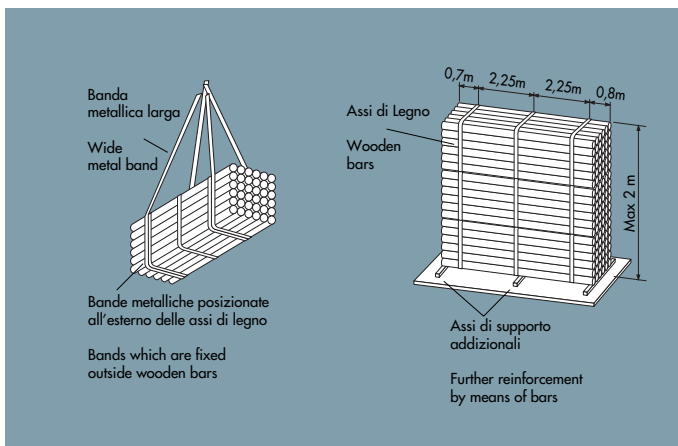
Movimentazione e stoccaggio - Handling and storage
